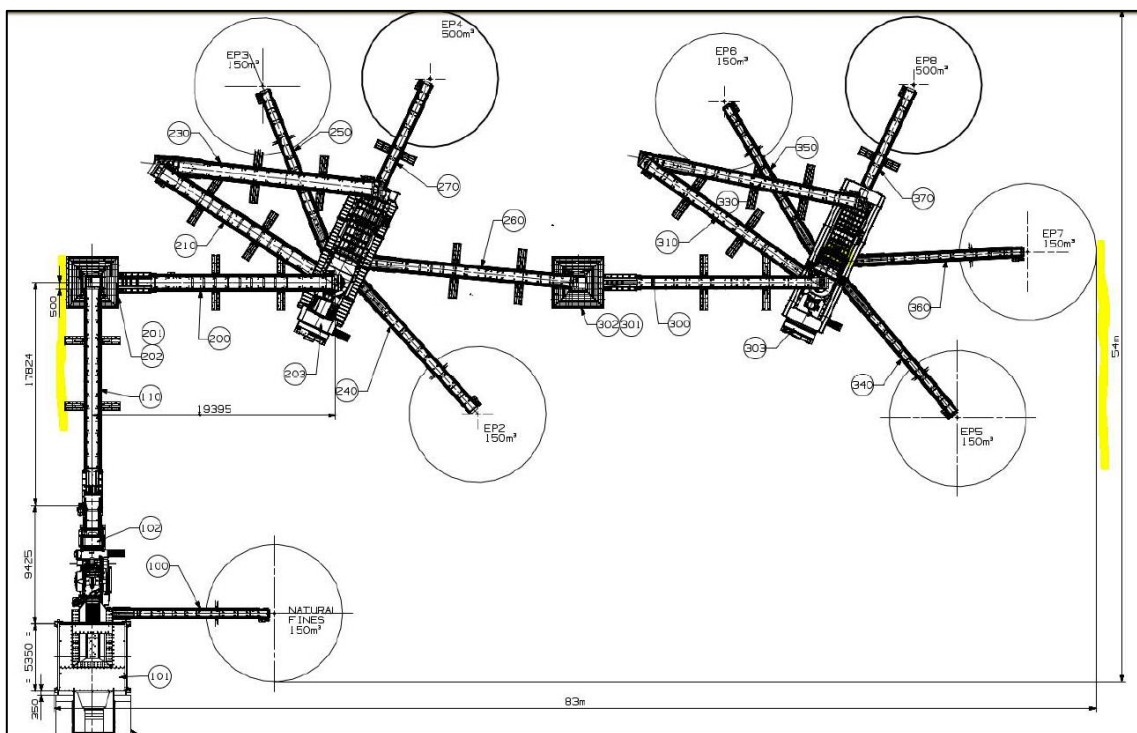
Plan de principe des installations fixes de traitement des matériaux
